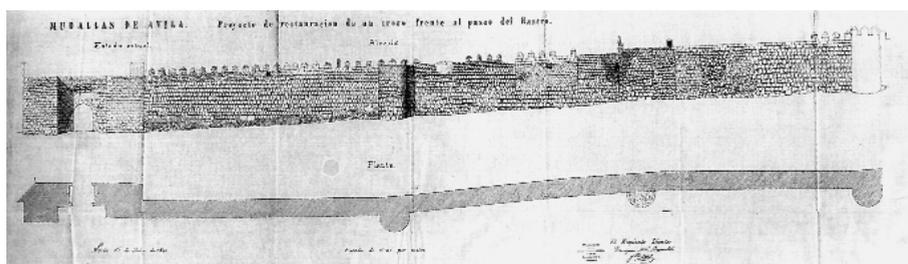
E. M. Repullés, 1891. Estado de la zona a restaurar con la puerta de Montenegro y el torreón 67 caído.
